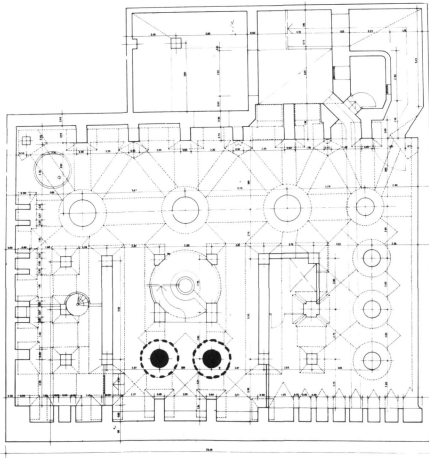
Los dos pilares de la planta sótano sin continuidad en la planta baja.
